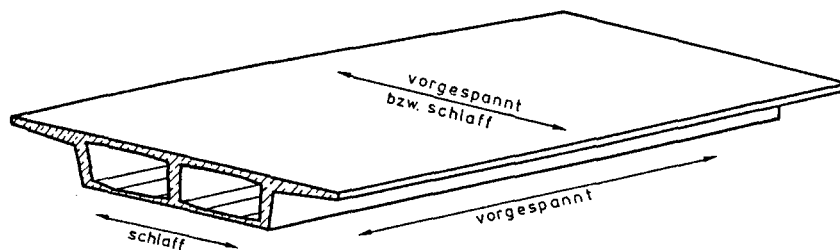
Übliche Kombinationen von Spannbeton - und Stahlbetonelementen bei Hohlkästen
